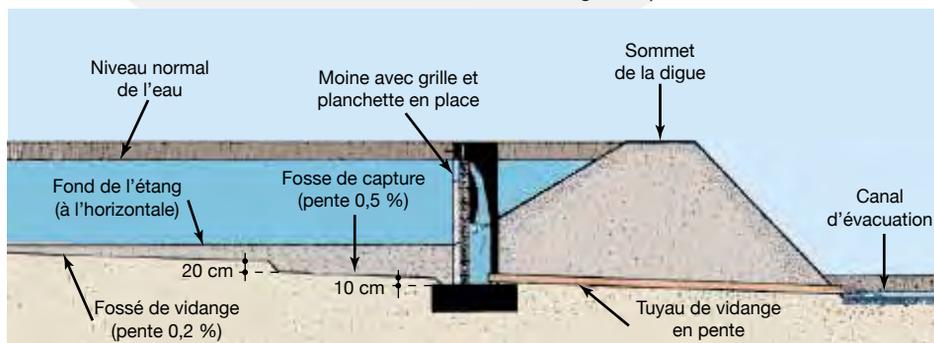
Coupe transversale d'un étang au niveau du fossé de vidange.
